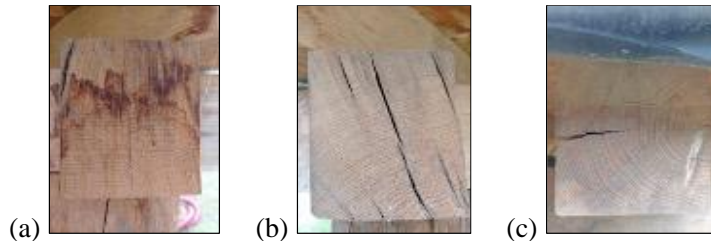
Sections transversales : (a) poutre A1 ; (b) poutre A2 ; (c) poutre A3
